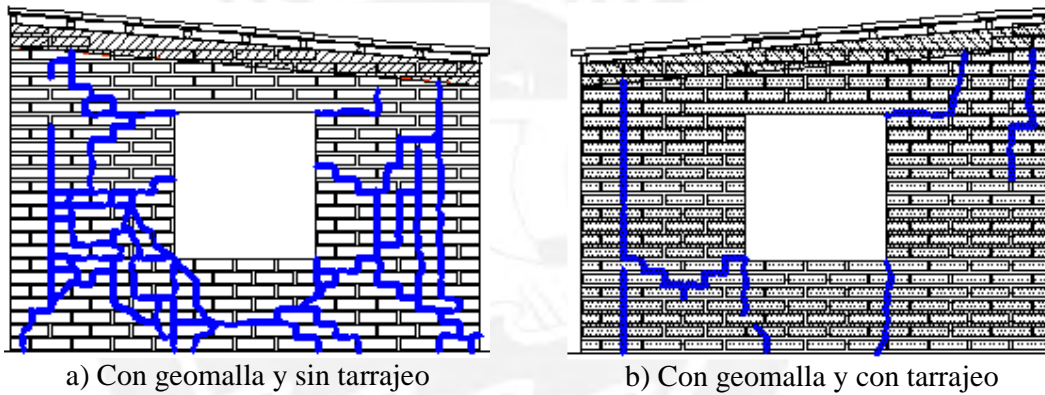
Levantamiento de fisuras del Muro de adobe con refuerzo de geomalla M5
